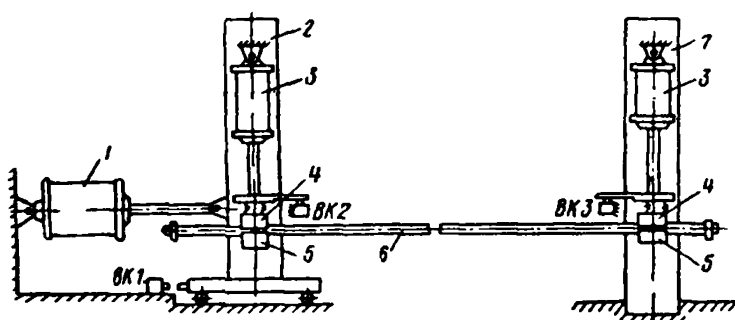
Схема автоматической установки для нагрева стержней с оттяжкой подвижной опоры
